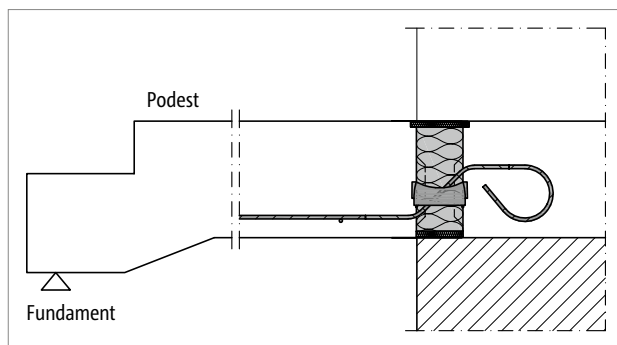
Schöck Isokorb® T Typ QL: Anschluss Treppenauf bei einschaligem, wärmedämmendem Mauerwerk
